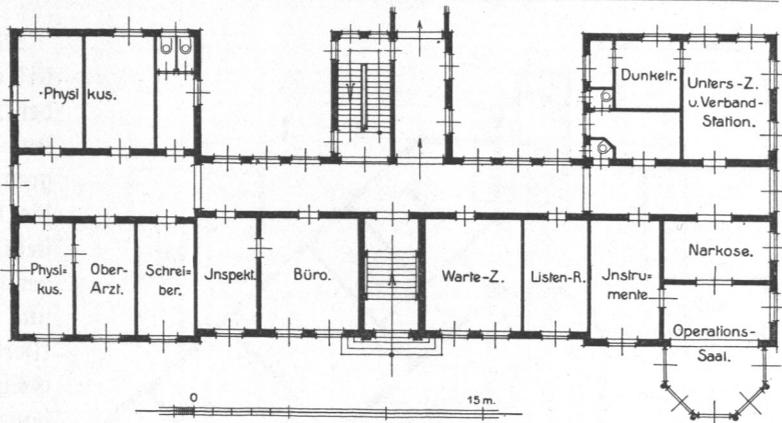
Hafenkrankenhause, Verwaltungsgebäude, Erdgeschoß, Grundriß.
